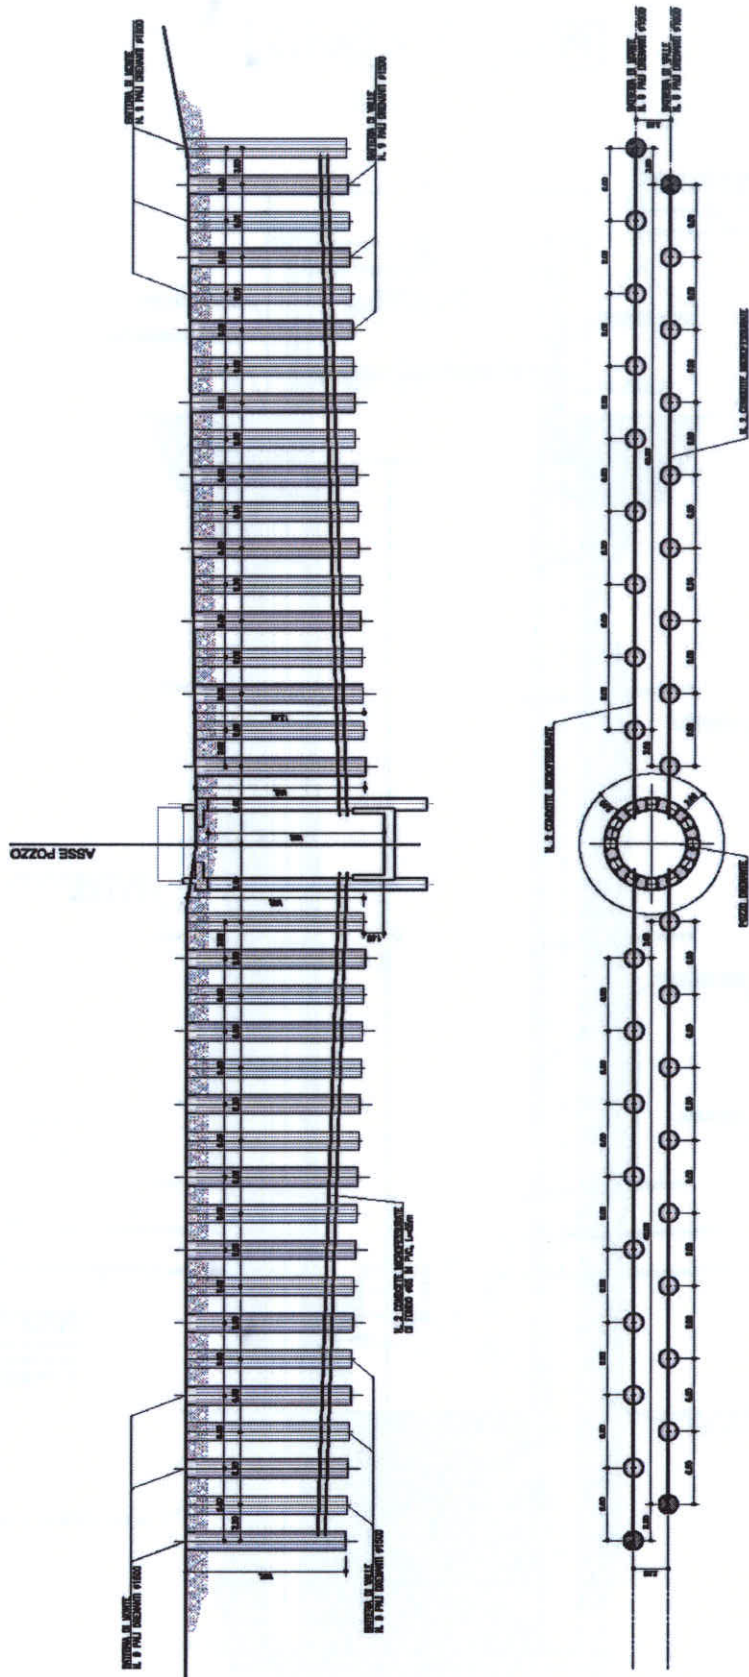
Pianta e sezione tipo delle aste drenanti
